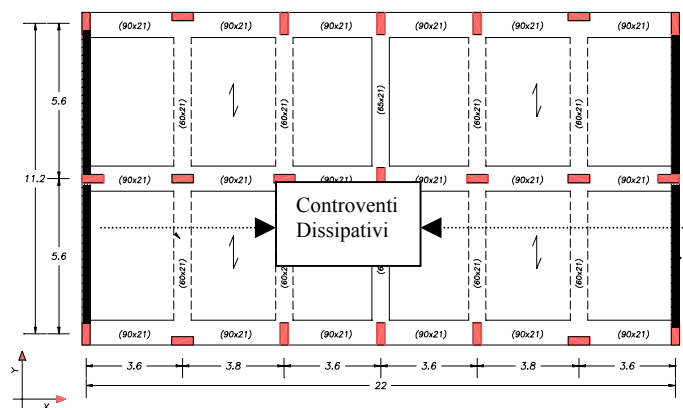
IACP: disposizione in pianta dei controventi dissipativi.
